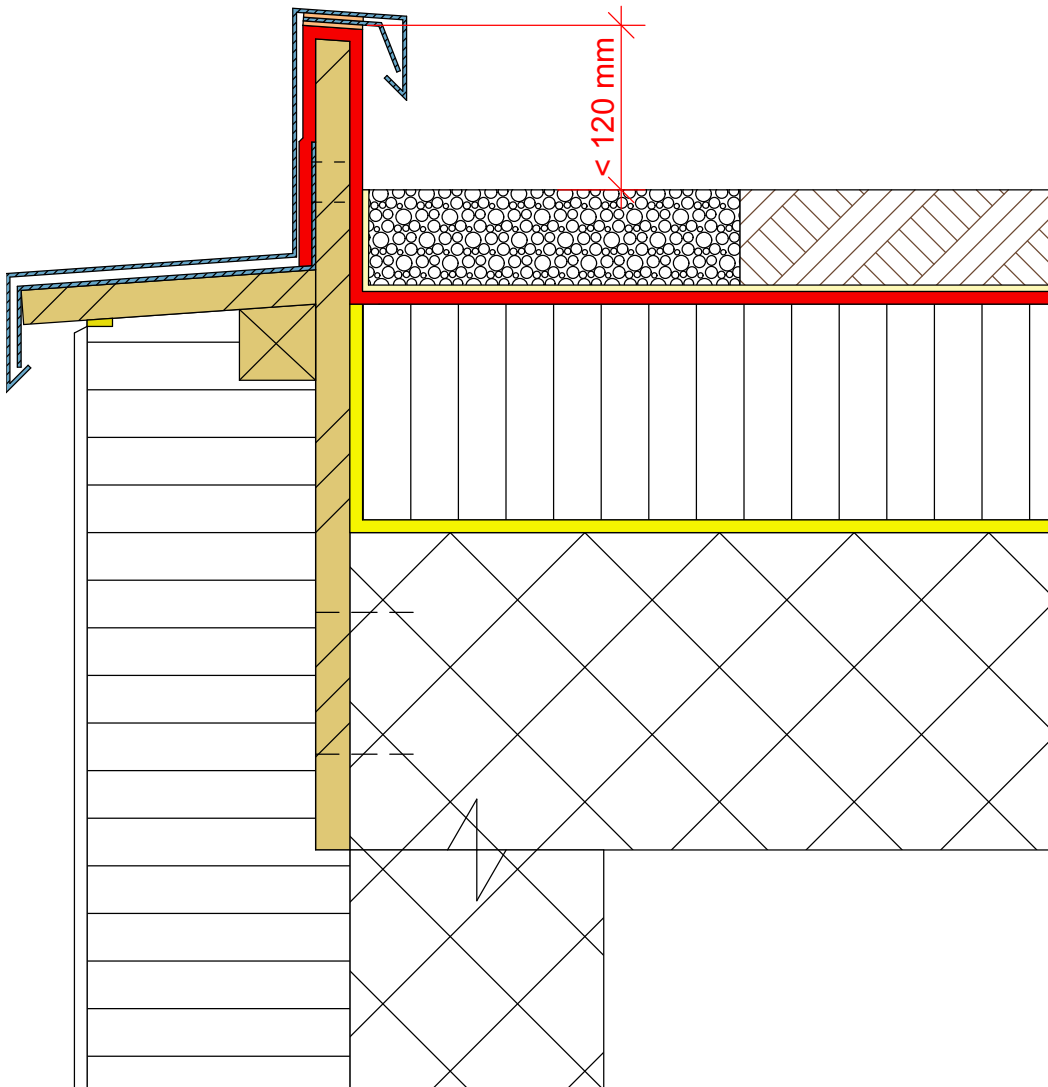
Überlaufsichere Dachrandkonstruktionen
